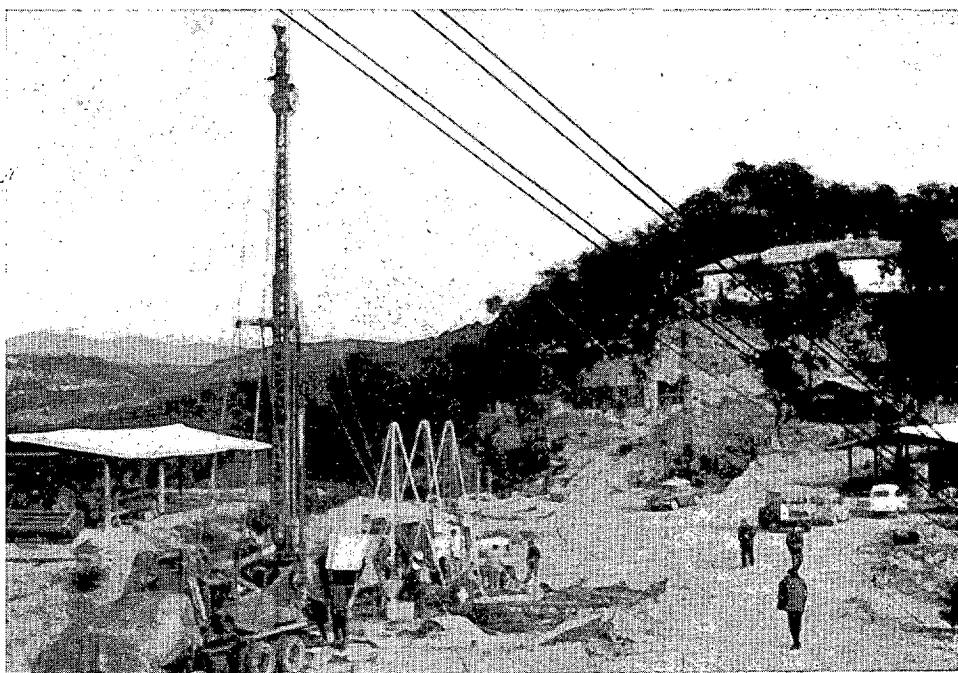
Conjunto de la instalación empleada para la construcción de la pantalla.
